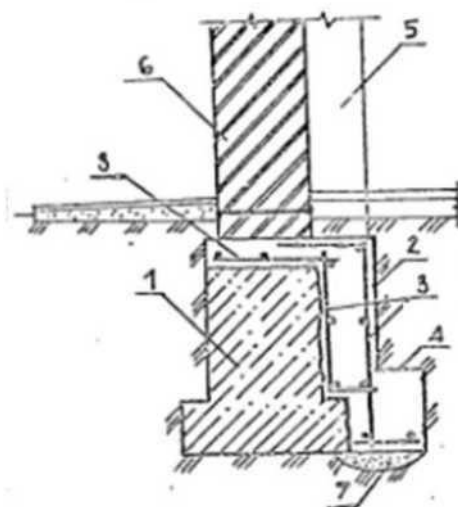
Устройство фундаментов под пилястры: 1- усиливаемый фундамент, 2- наращиваемый фундамент; 3- арматура усиления; 4- поверхность подготовки к бетонированию (насечка); 5- пилястра.
